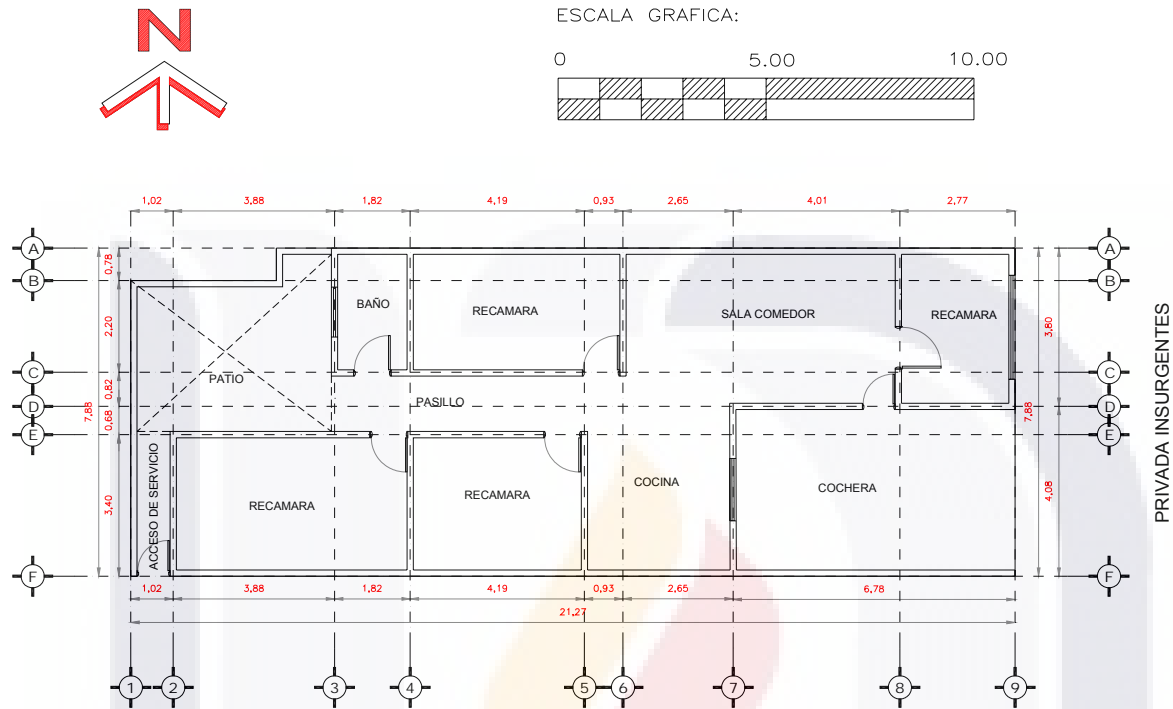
Plano arquitectónico de la casa habitación en estudio.
